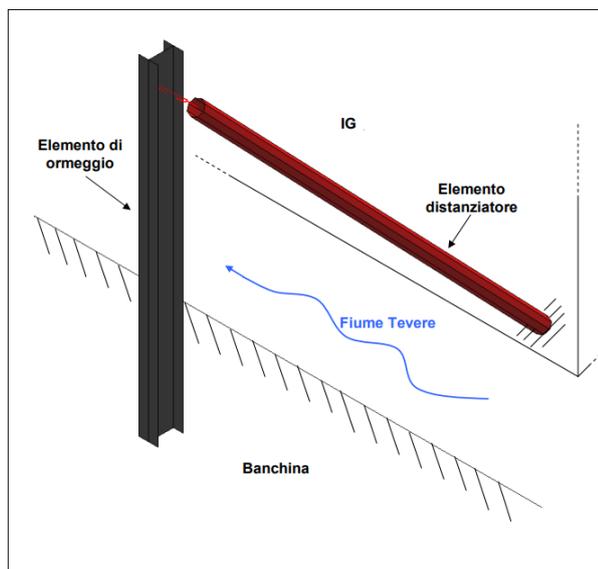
ormeggio per *Installazione Galleggiante* con bracci distanziatori, dettaglio dell'elemento di ormeggio [da L.G. *Autorità di bacino del Tevere*].
